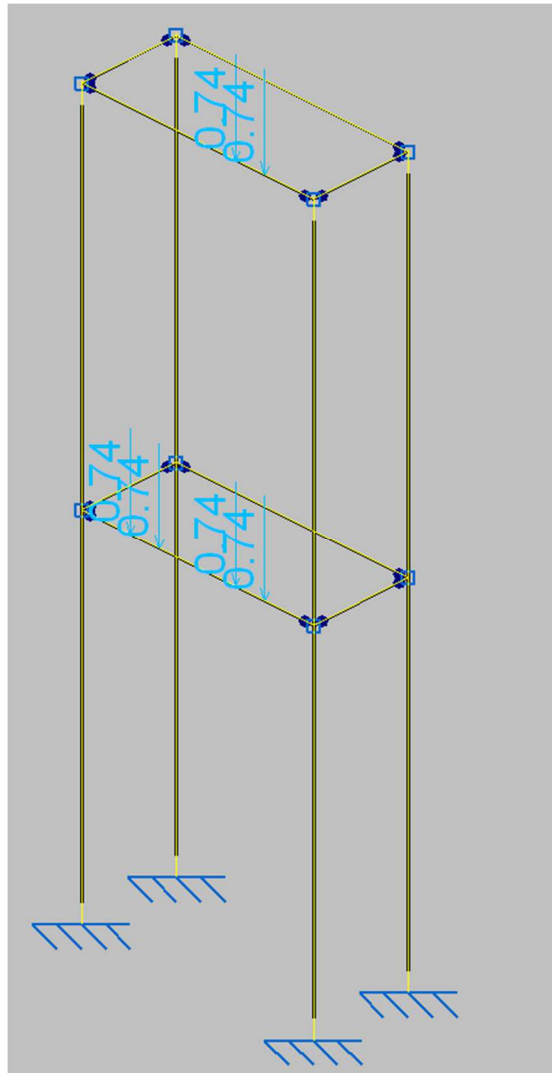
Cargas aplicadas en la estructura inferior de las escaleras
